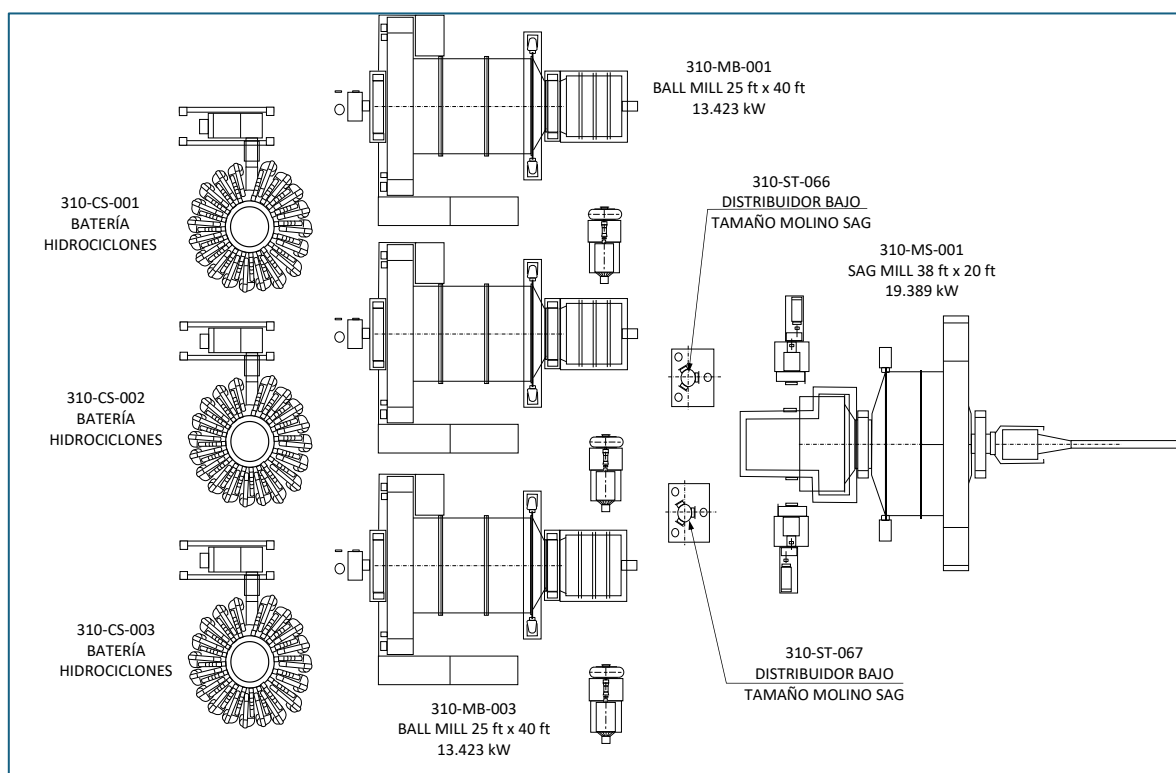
Esquema Planta de Molienda Laguna Seca Proyecto Original
